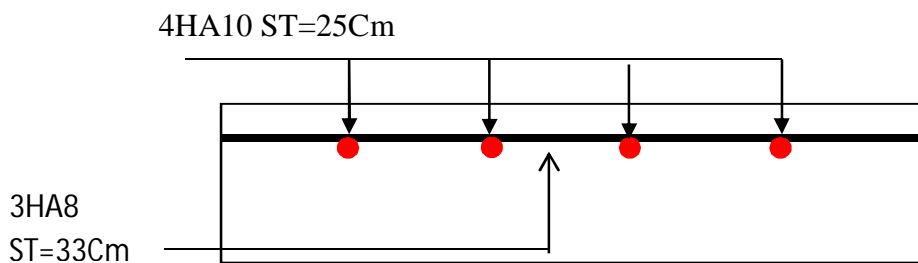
Schéma de ferrailage de palier intermédiaire (dalle sur un seul appui)
